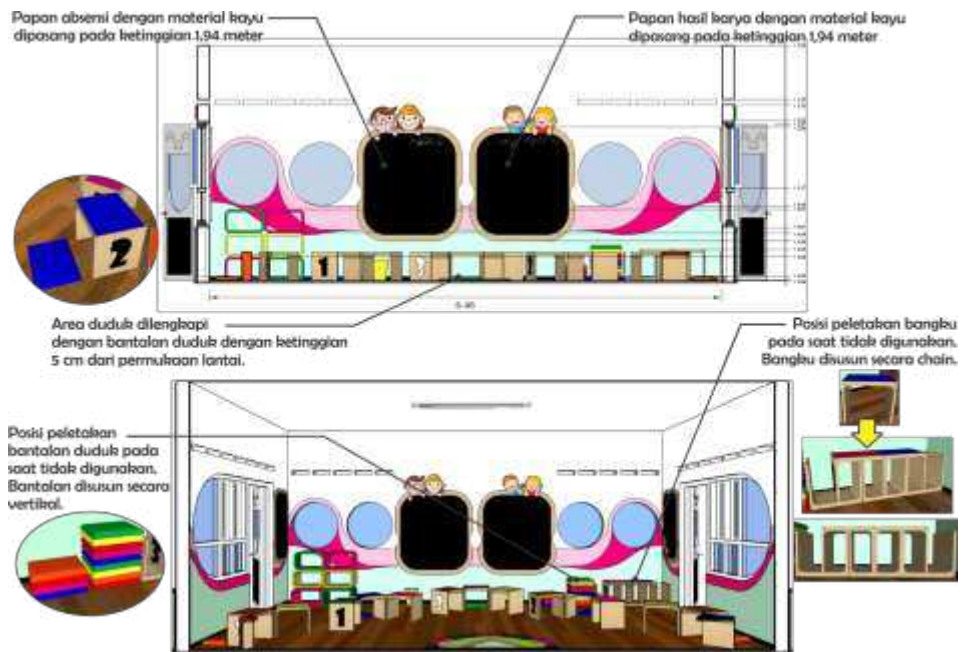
Denah dan Denah Orthogonal Ruang Kelas AT
